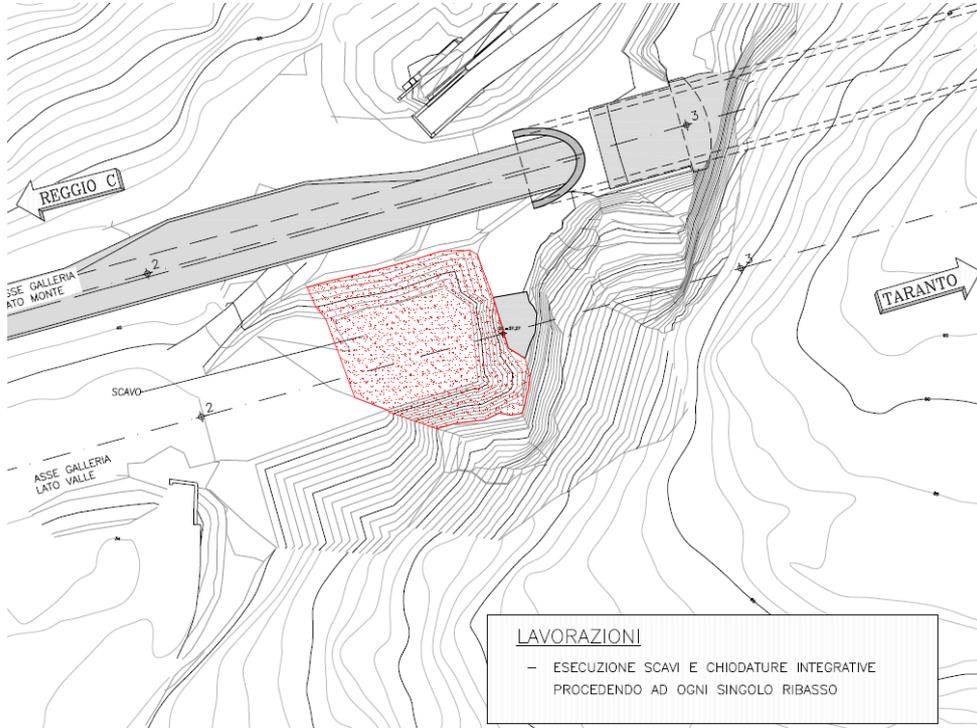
Galleria Peristeri – Fase 1 – Lato RC
